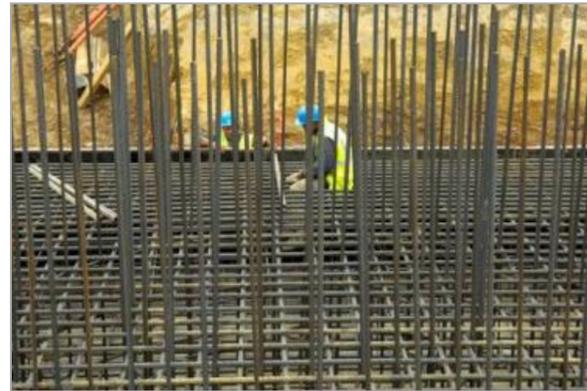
Ferrailage de la fondation (source : VESTAS)
